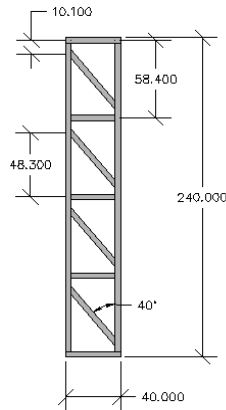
Geometria dos pilares-treliça (unidade de medida em cm)
